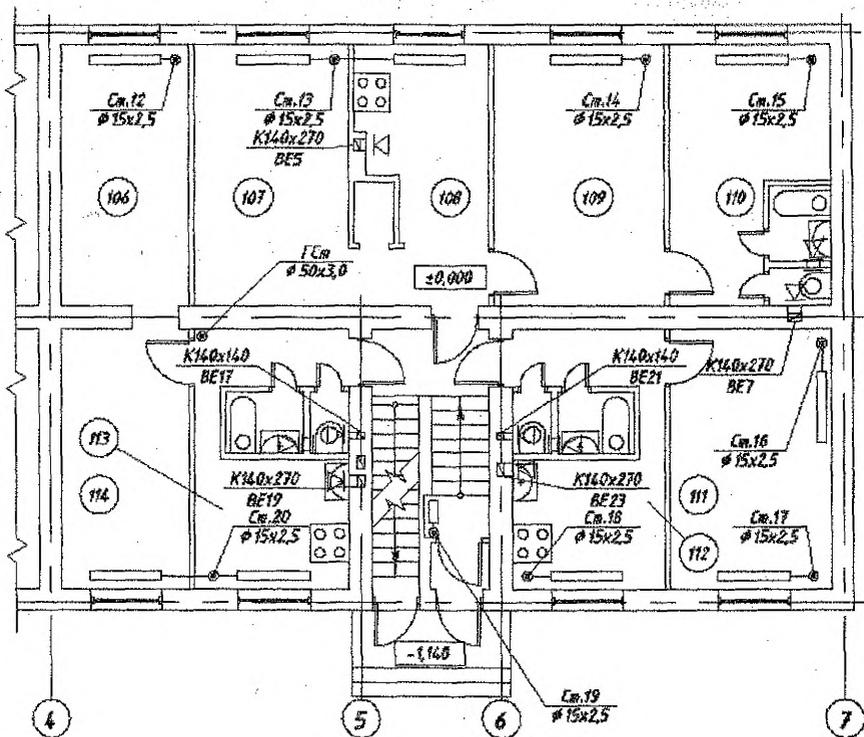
Пример расположения элементов системы отопления и вентиляции на плане этажа
